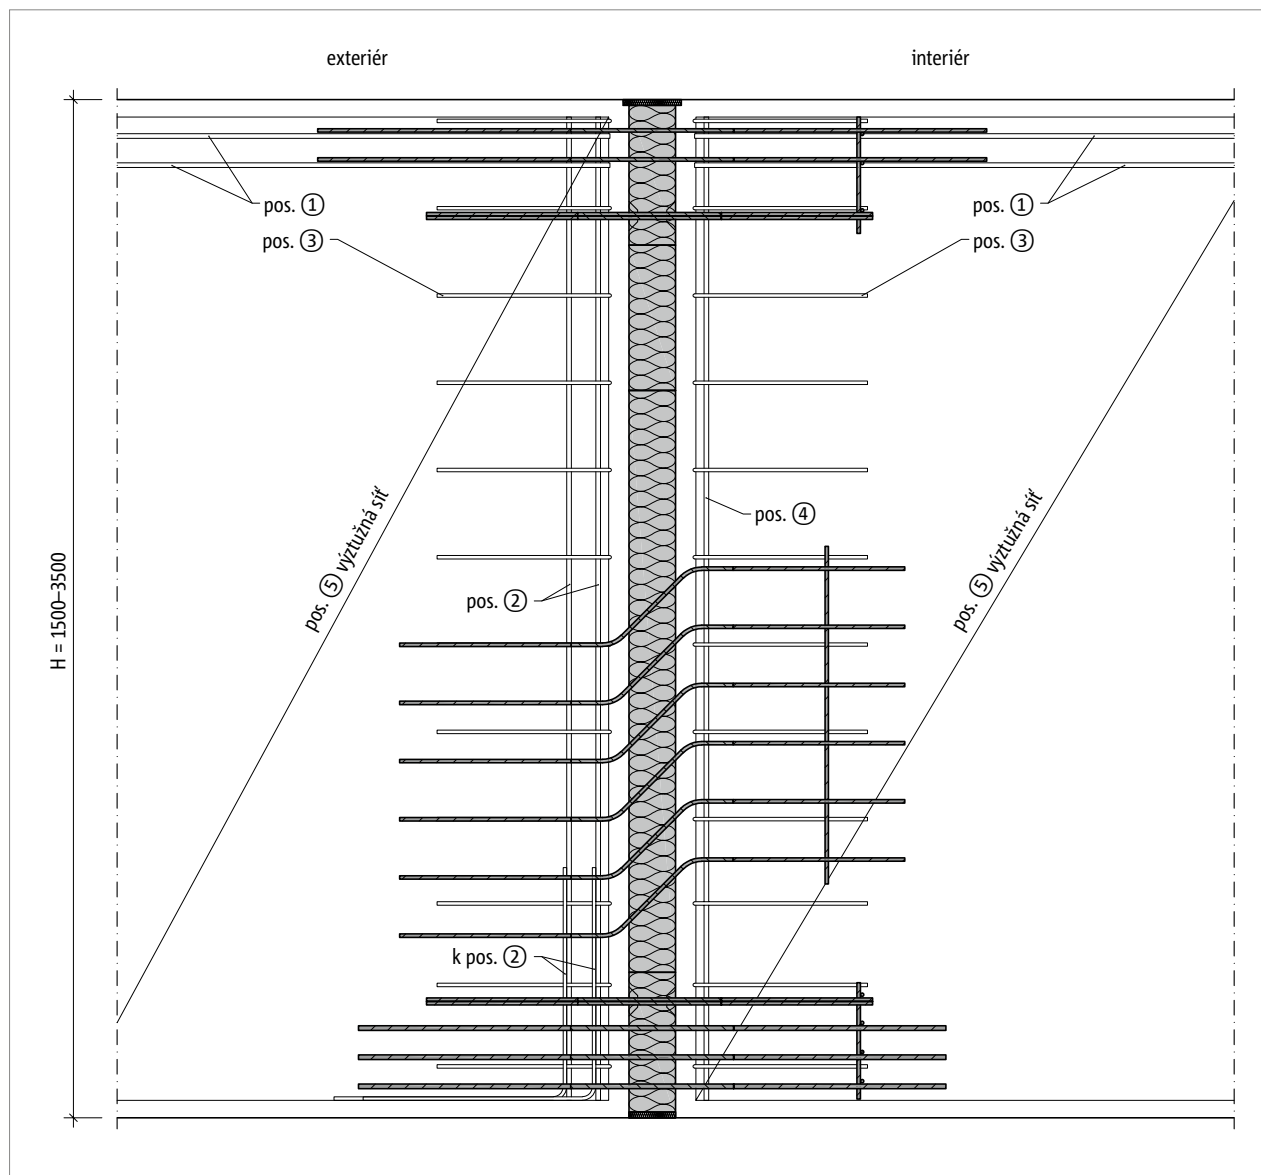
Schöck Isokorb® T typ WL-M4: Půdorys prvku
